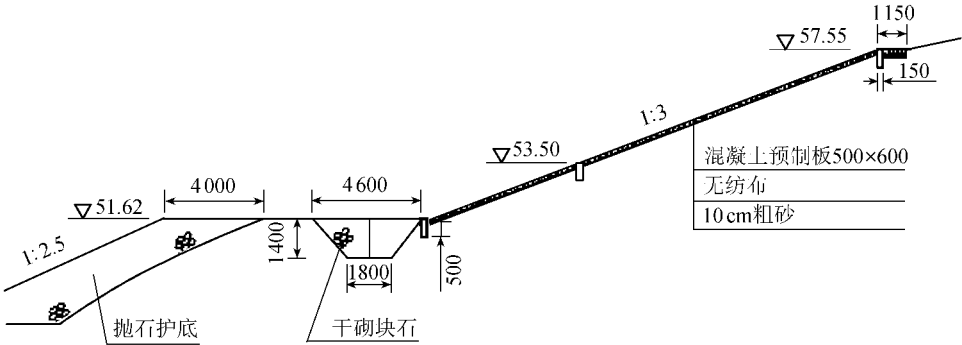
黑龙江流域混凝土预制板护坡典型断面示意图(单位:mm)
